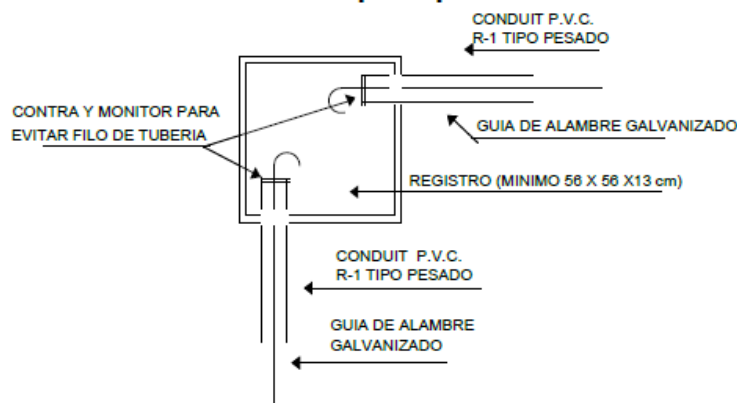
Canalización de la Fibra Óptica por Tubería Conduit de PVC.
